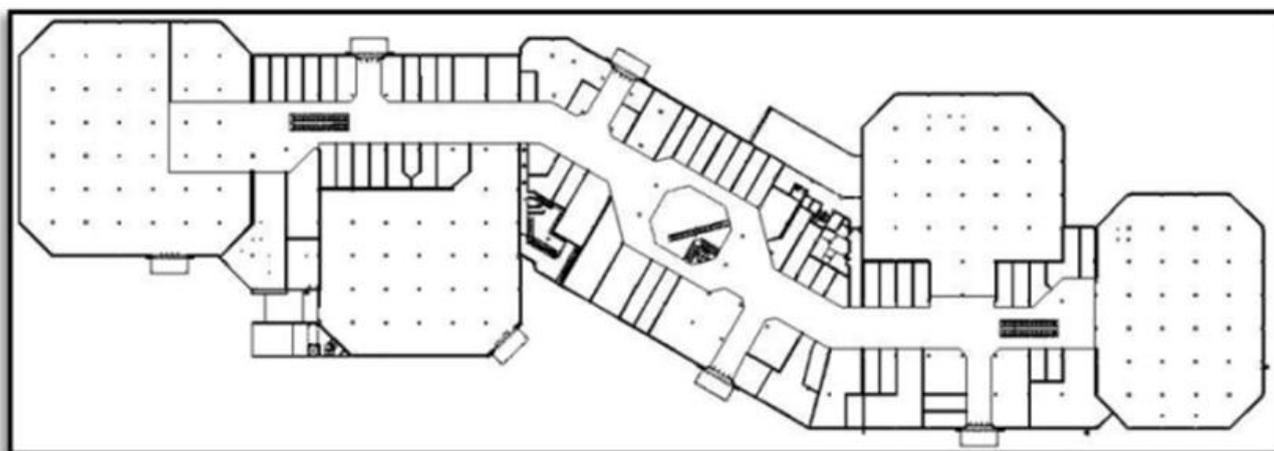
Planta baixa Shopping - Maceió Shopping Pavimento 02 (2009).
